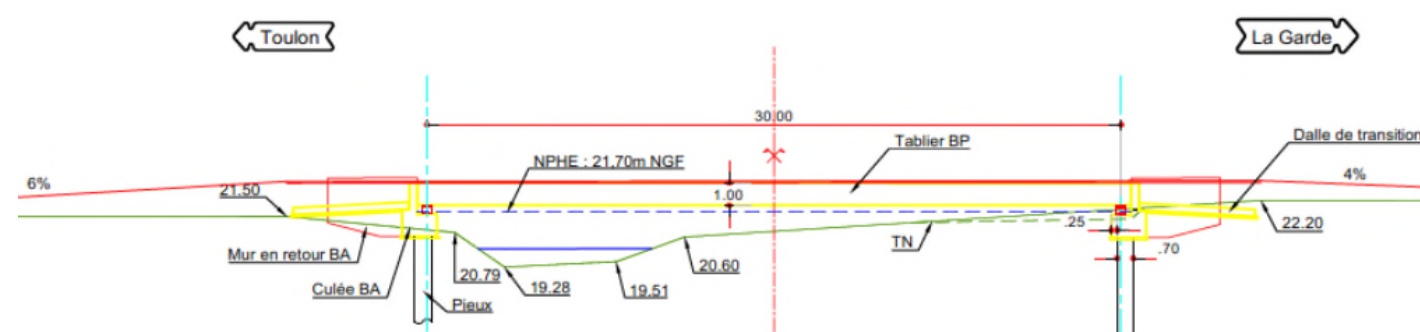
OUVRAGE HYDRAULIQUE SUR LE SAINT-JOSEPH – PROFIL EN TRAVERS
